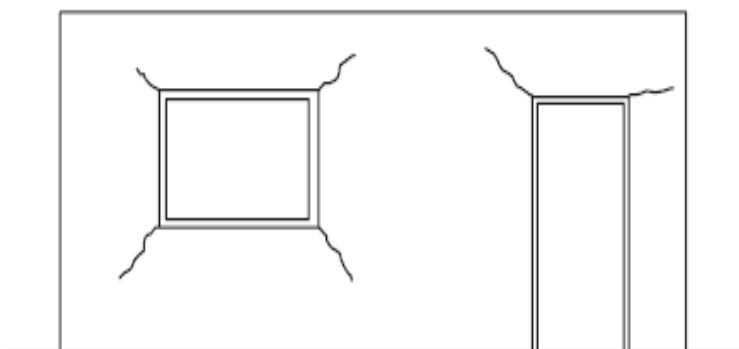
Trincas e fissuras teóricas em painéis de alvenaria com aberturas.
